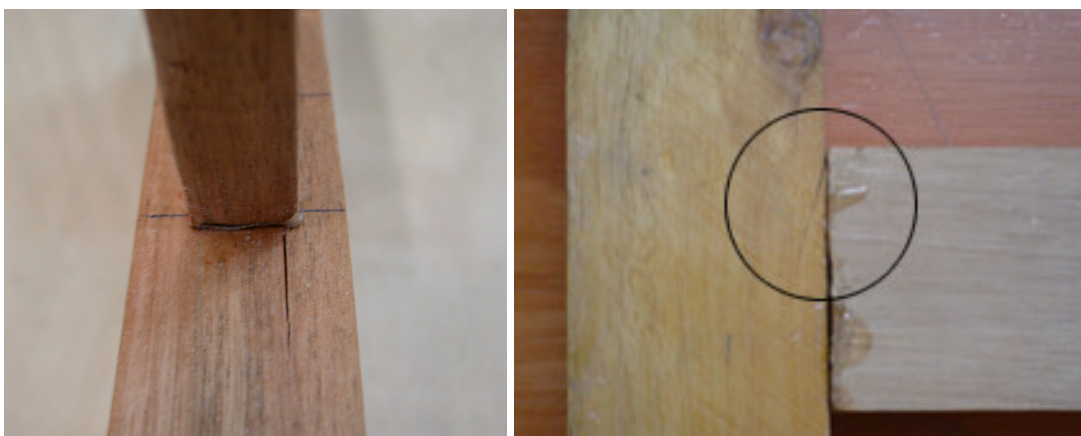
Rachaduras paralelas às fibras do montante na parte inferior e superior
